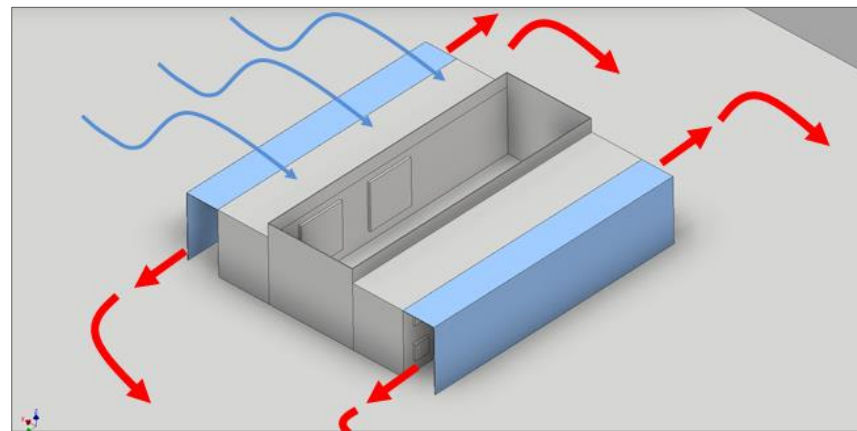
Эскиз ЭКМ ЦОДа с установленными боковыми форкамерами
